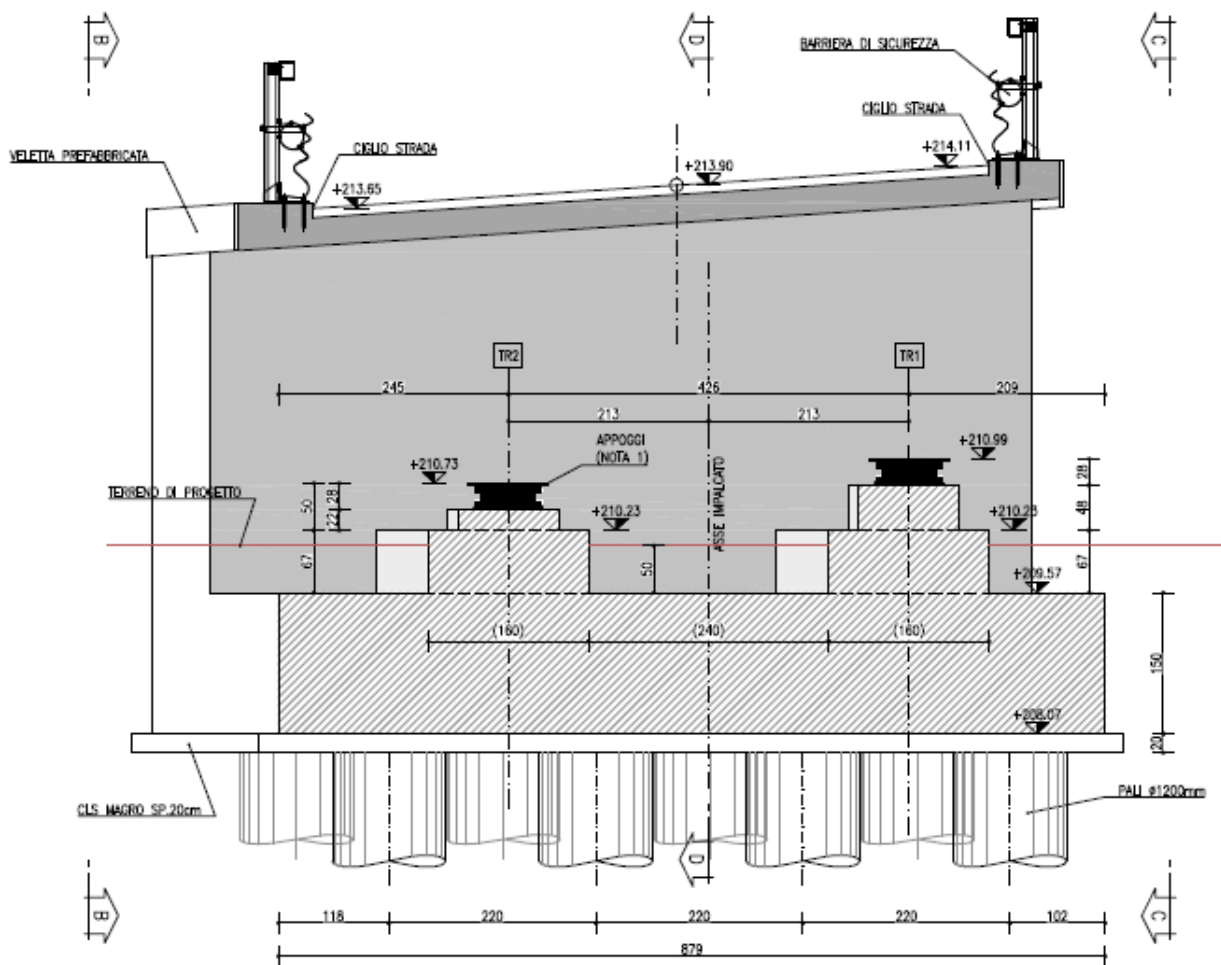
Spalla 1 - carpenteria elevazioni
